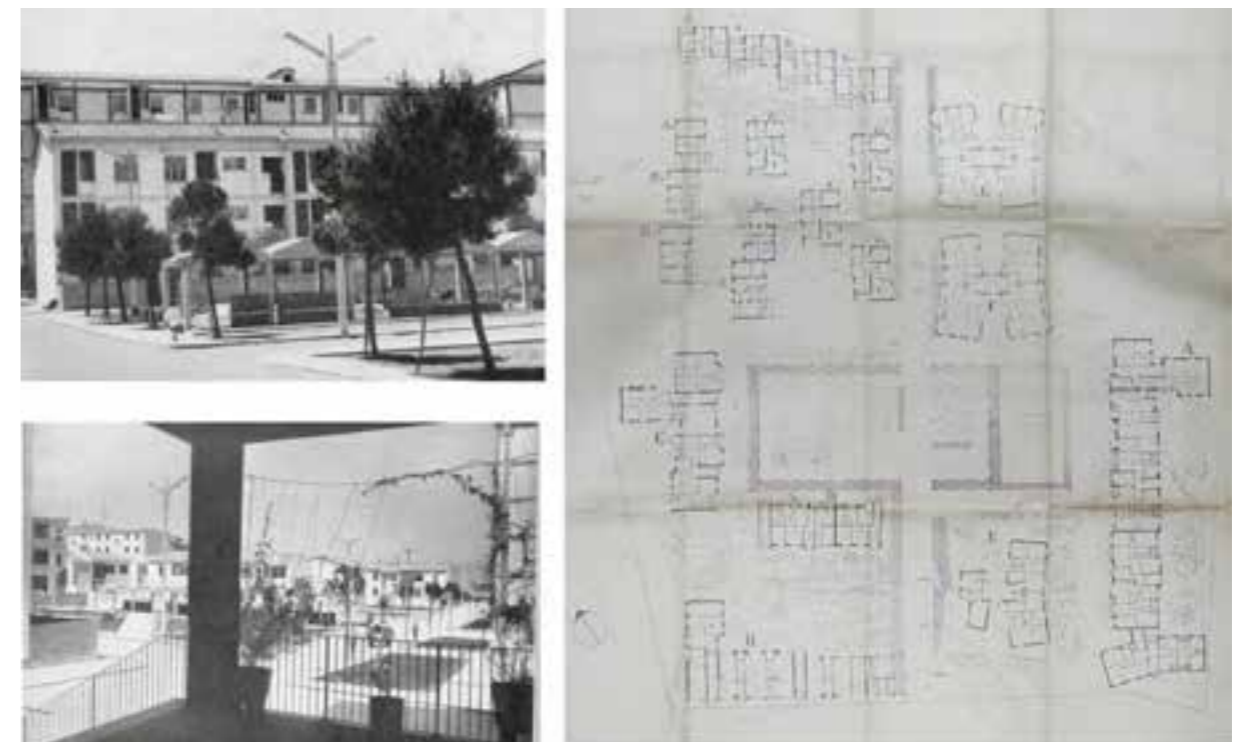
Masterplan del concorso di progettazione dell'architetto Maurizio Sacripanti e foto storiche della relazione tra spazio aperto e edifici residenziali. (Archivio Soprintendenza di Cagliari).
